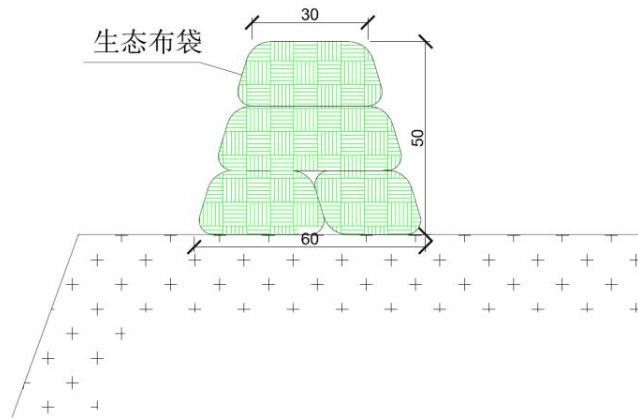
台阶外缘生态布袋挡土墙截面示意图（单位：cm）
